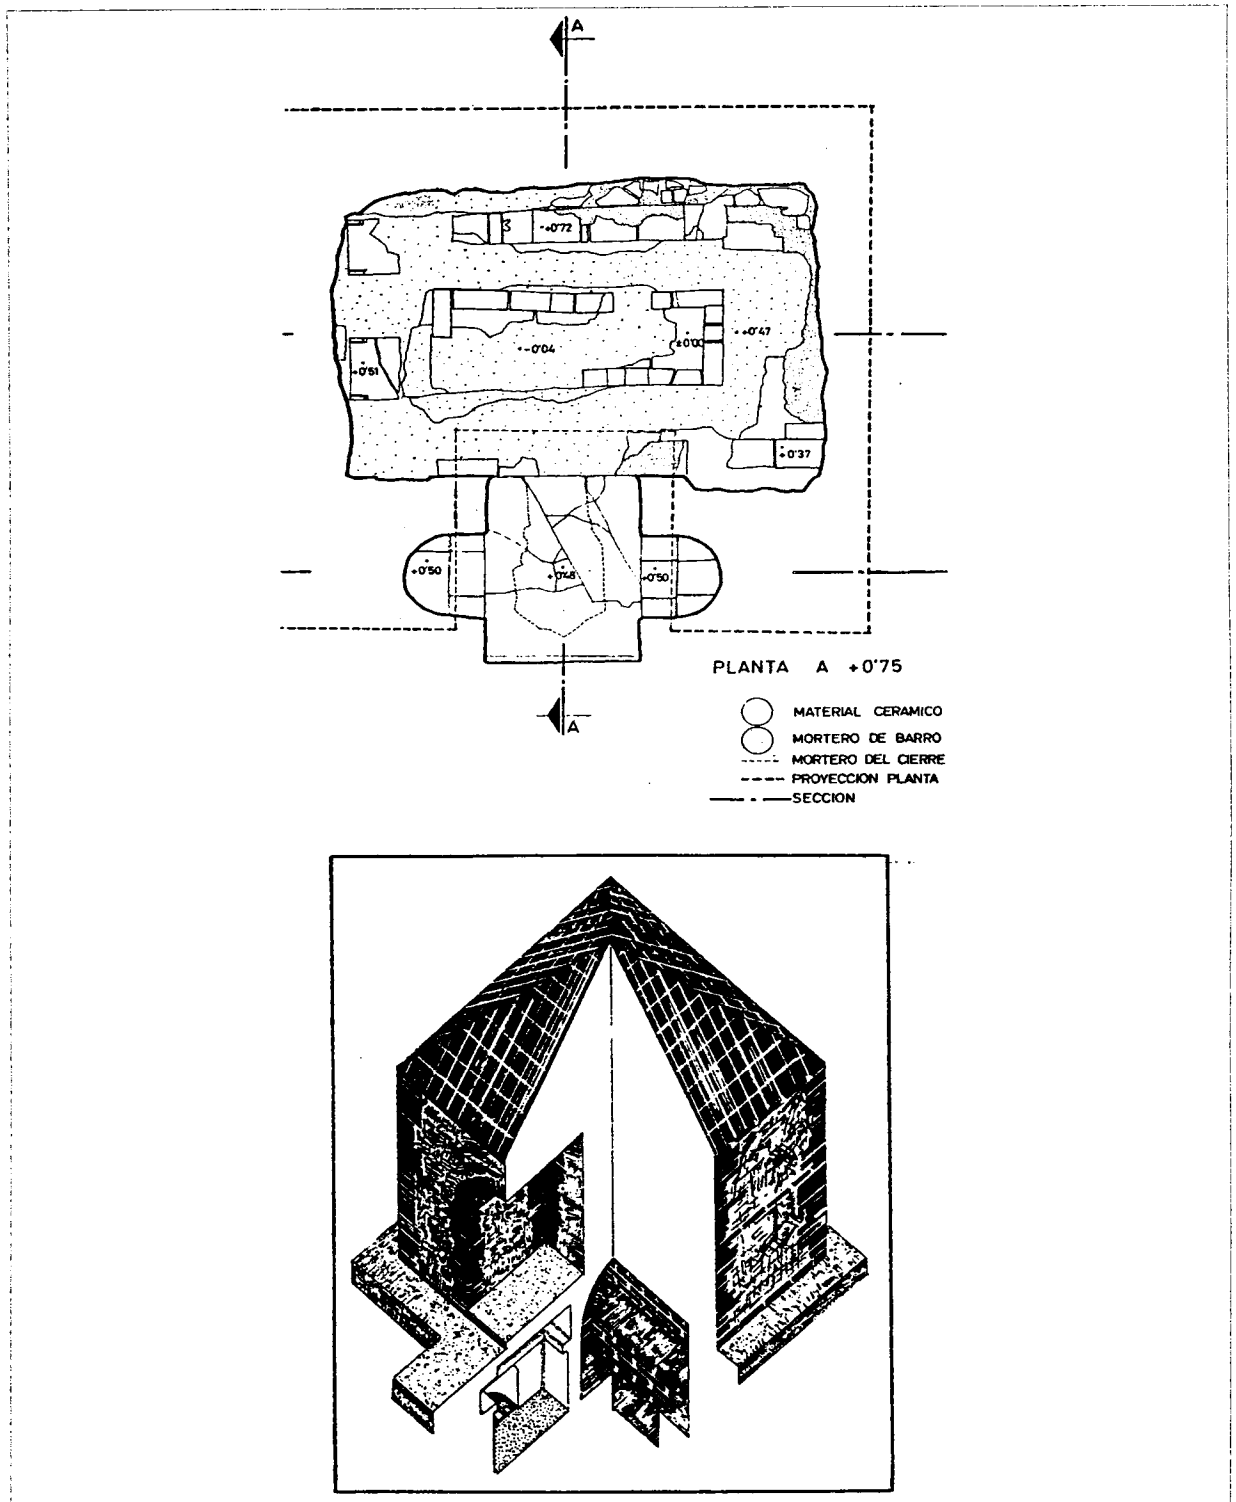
Sepulchro Turriforme de Fuente Seca (Aroche). Planta y Alzado.
